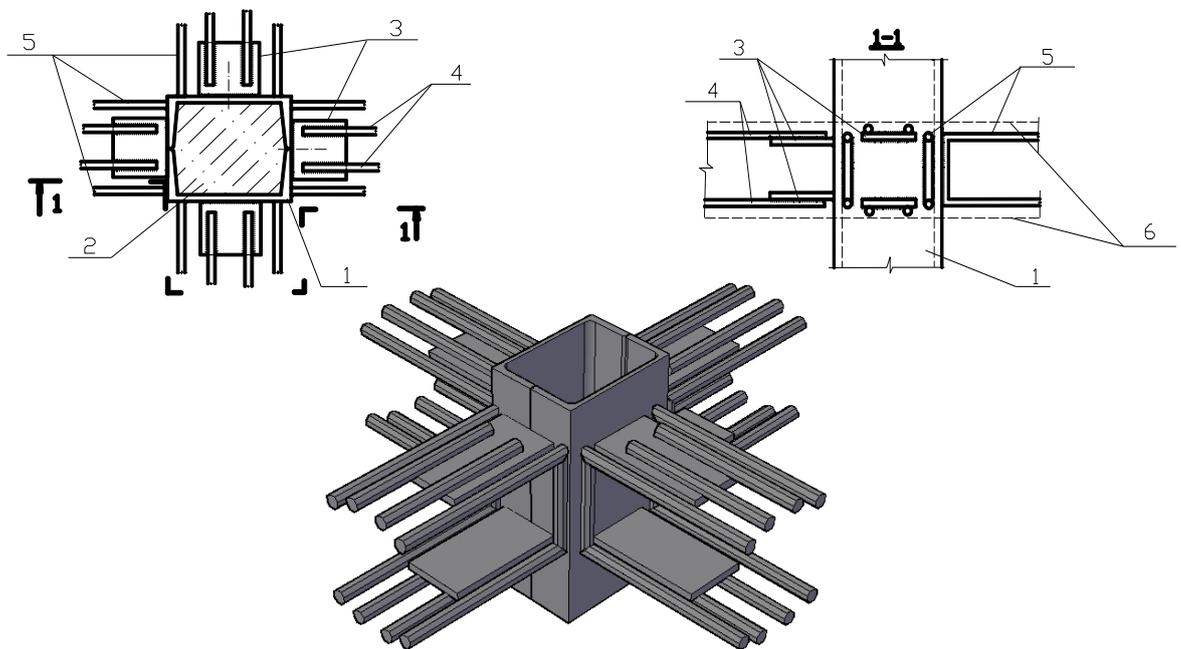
Безкапітальний вузол з’єднання монолітного без балочного перекриття з колонами зі швелерів:
